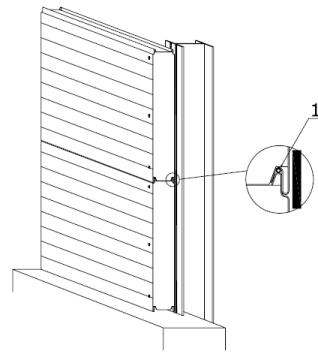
Установка уплотнителя. 1 – трубчатый уплотнитель (герметик)
